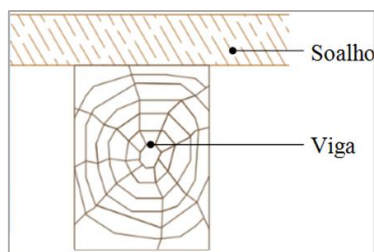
Esquema da solução de pavimento existente sem teto
